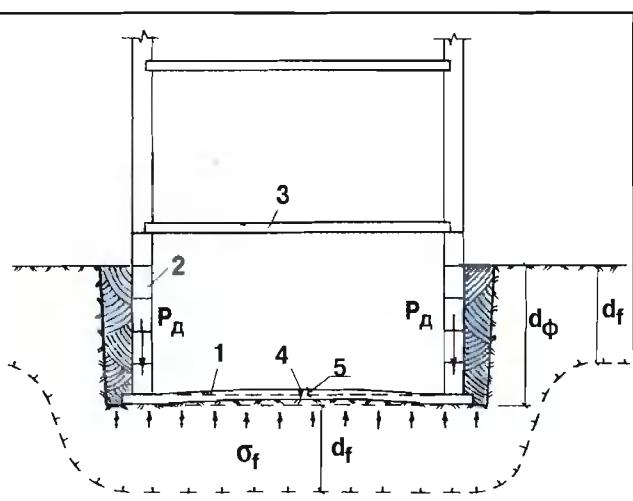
Схема разрушения фундаментной плиты под действием сил пучения: 1 — фундаментная плита; 2 — стены цокольного этажа из фундаментных блоков ФБС; 3 — плита цокольного перекрытия; 4 — трещина; 5 — стрела прогиба; d_f — глубина промерзания грунта; d_ϕ — глубина заложения фундаментной плиты; P_d — нагрузка от дома на плиту; σ_f — давление пучения на плиту
